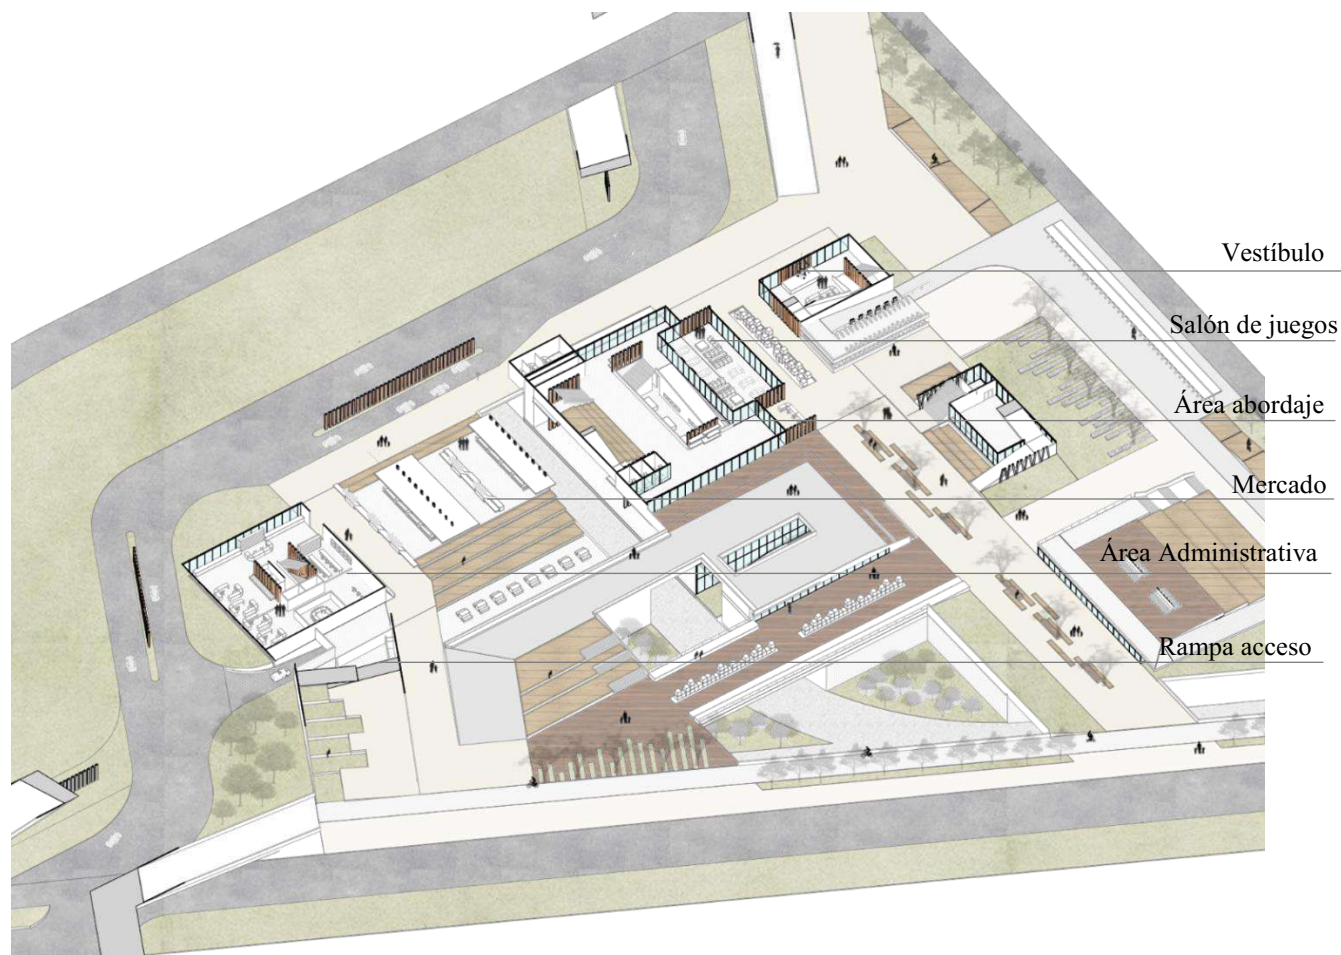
Planta axonometría primer nivel. Elaboración propia.
